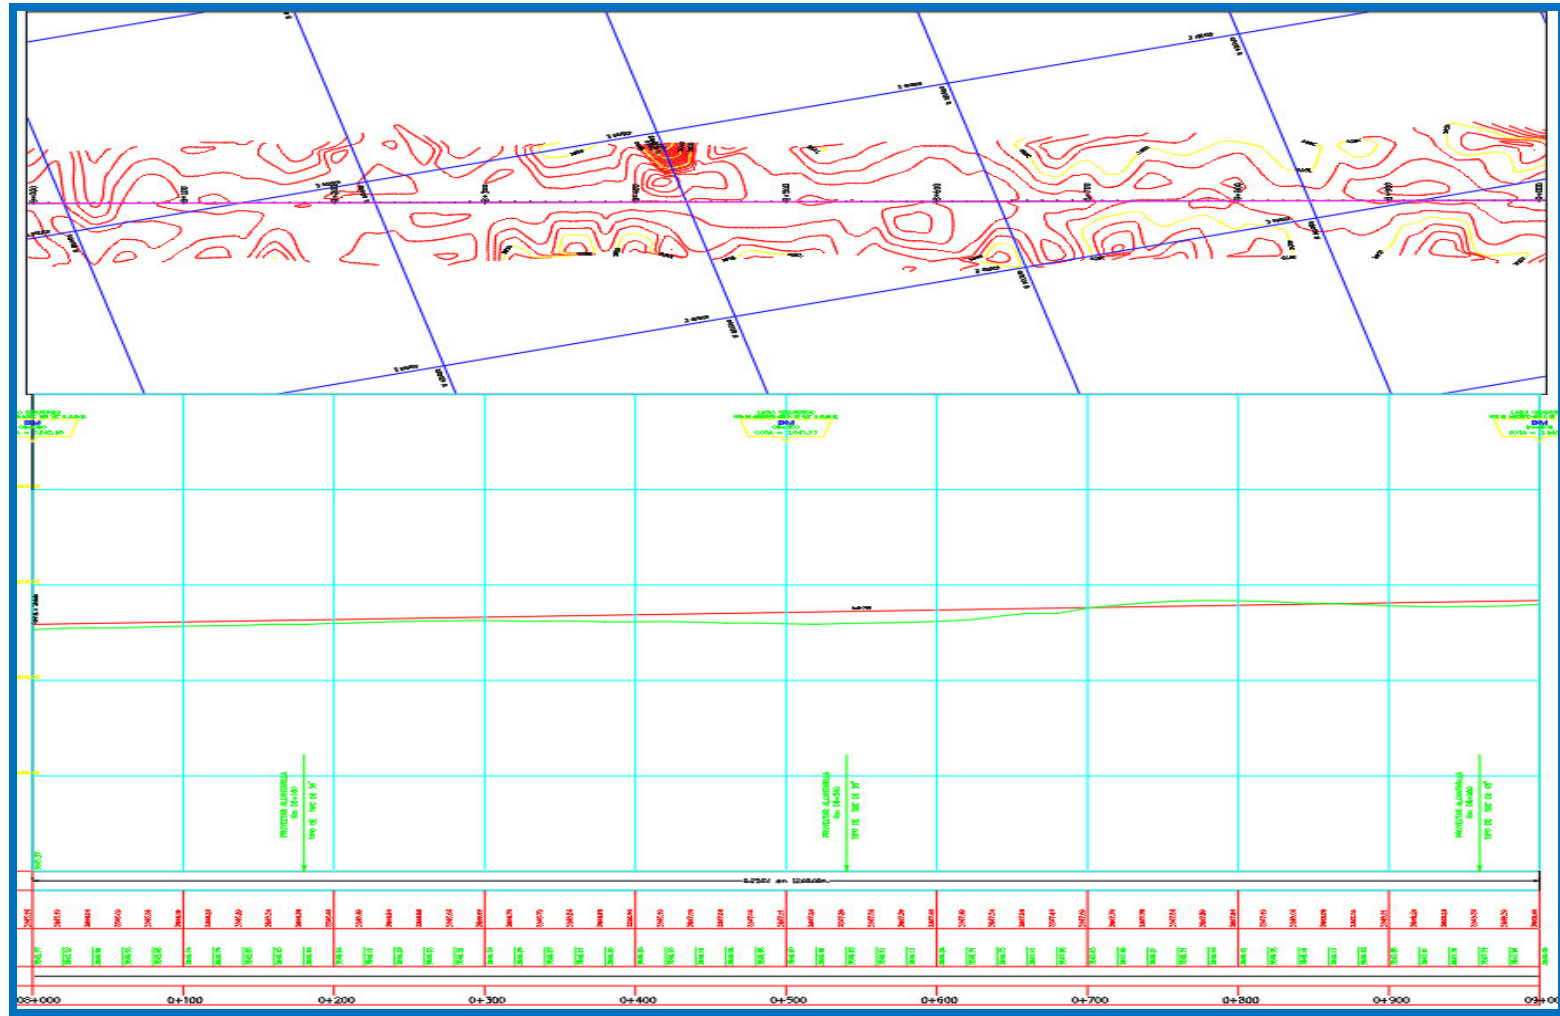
Plano de planta y perfil longitudinal (km 06+00-07+00)
